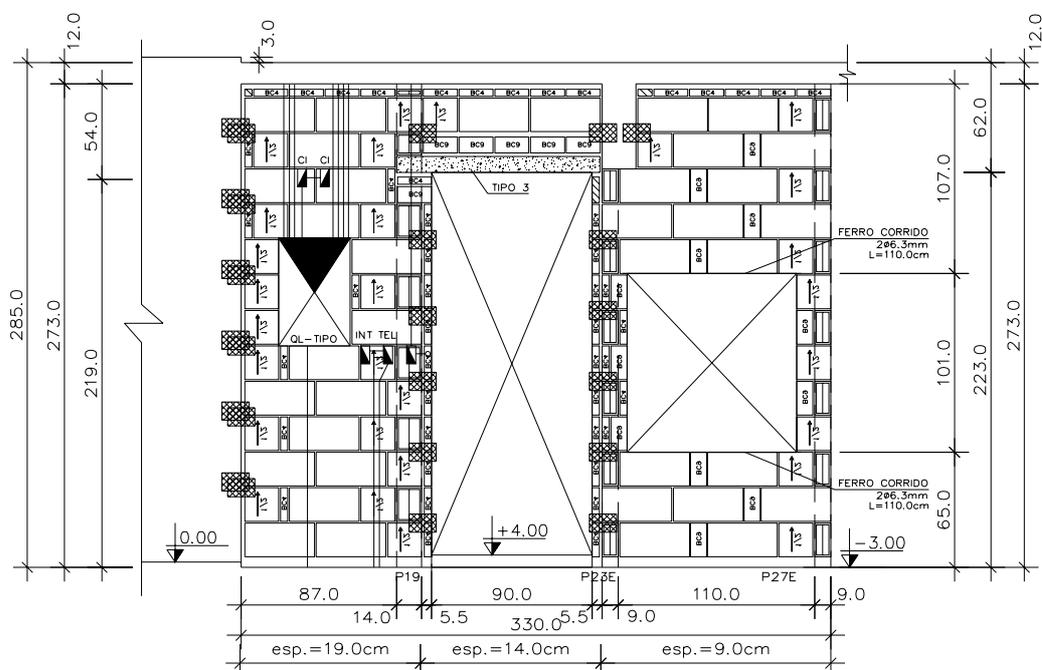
Elevação da parede do quadro de luz no projeto de vedação.
